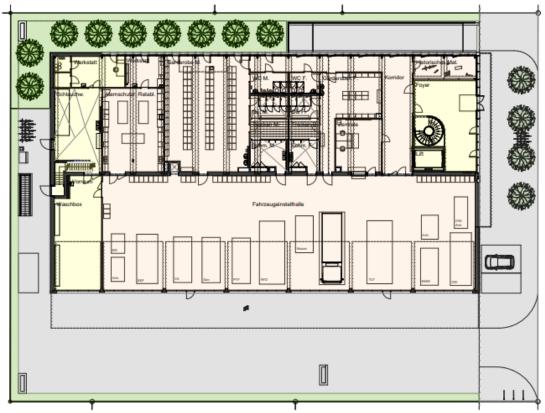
Grundriss Erdgeschoss inkl. Umgebung
